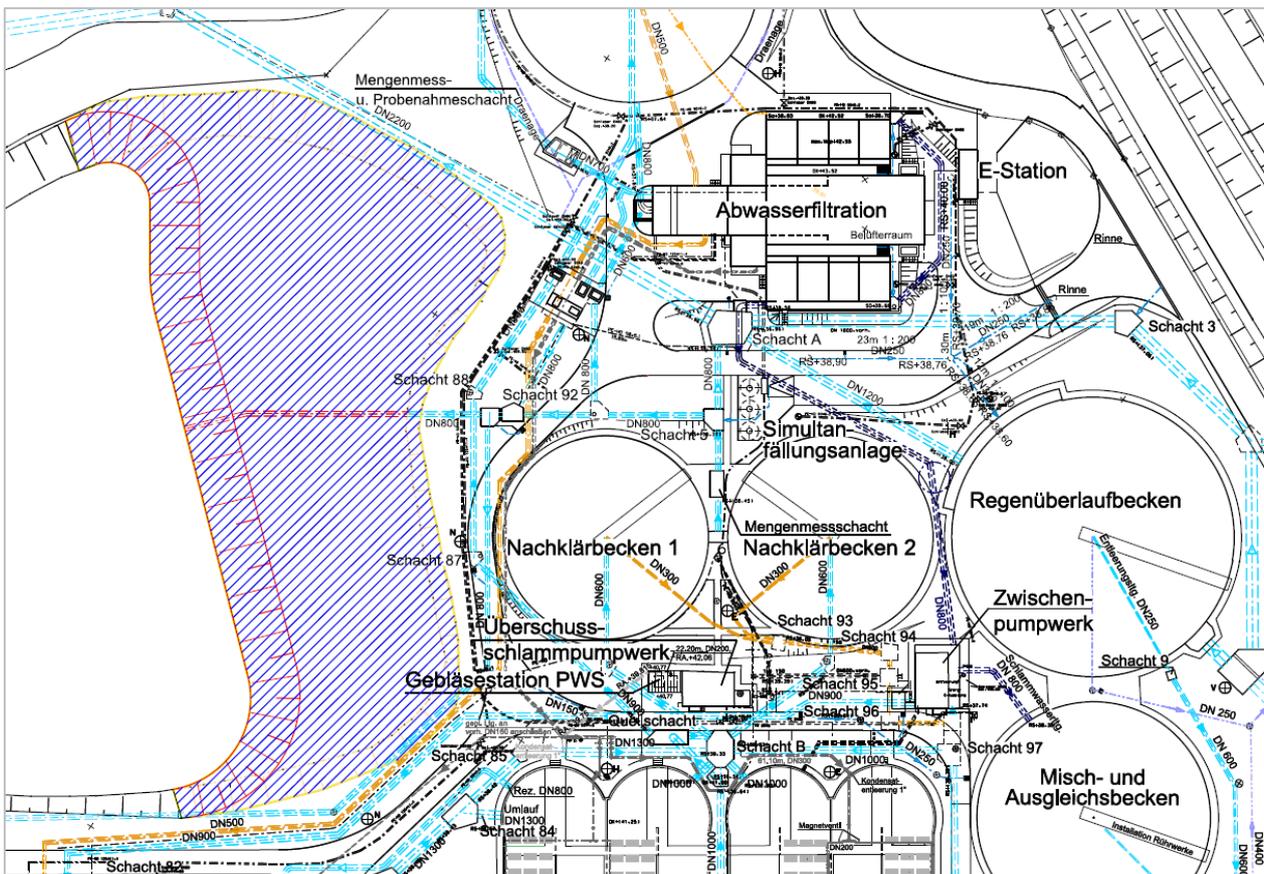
Lageplanausschnitt KA Borken mit Teilanfüllung Teich 1 (schraffiert)
